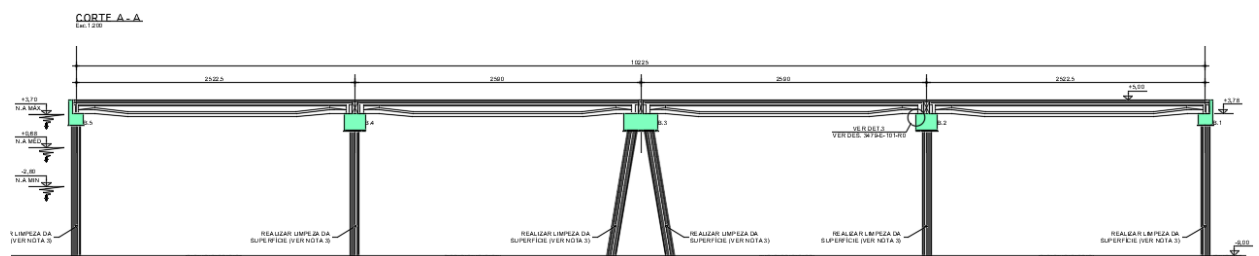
Elevação da OAE – Ponte de Acesso – Travessas com desprendimento do concreto.
